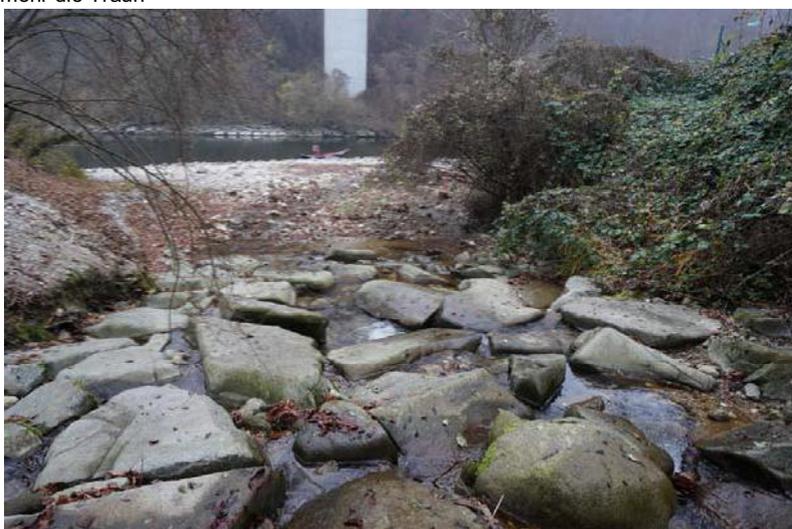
Blick von der Blocksteinrampe Richtung Traun – gut ersichtlich die geringe Wasserführung des Wasserlosen Baches
